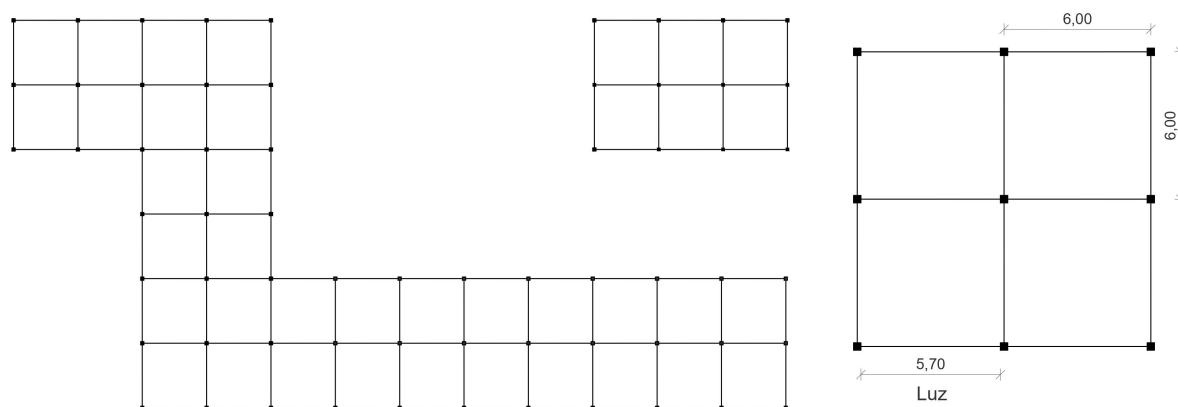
Malla estructural con módulos de 6 m x 6 m y una luz de 5.70 m. Fuente y elaboración: Autores
